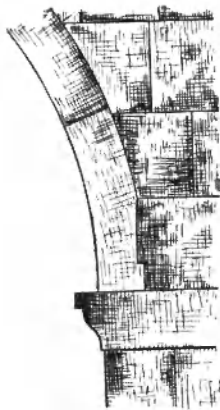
Форма пятового камня перекрещивающихся арок перекрытия колокольни Санаина
